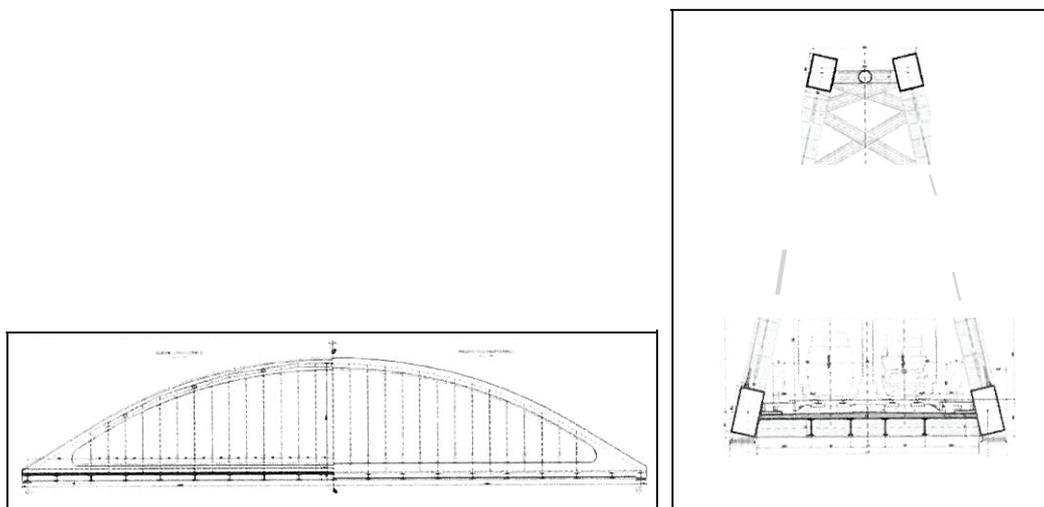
Profilo e sezione del ponte sulla Dora Riparia – Opzione struttura ad arco superiore
